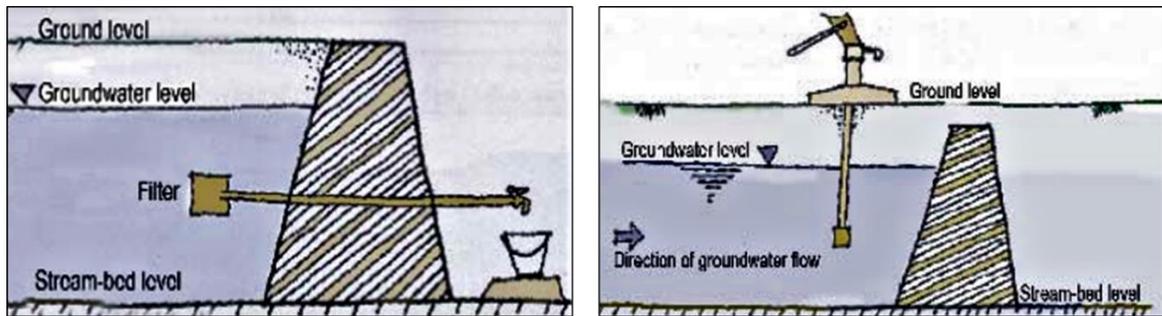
Presa subterránea de hormigón. Fuente: Sam Sam Water
